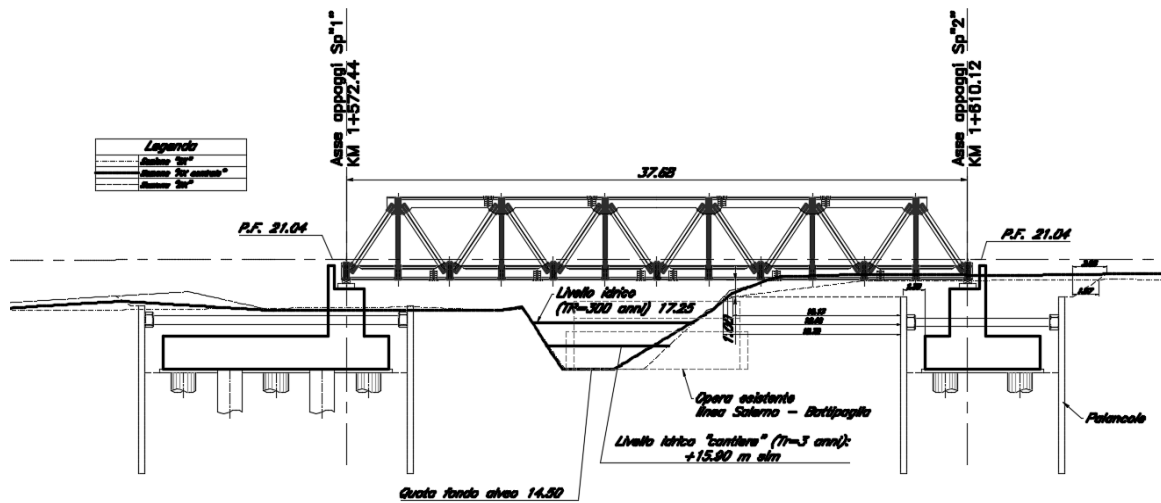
VIADOTTO VI 01 –Sezione longitudinale
